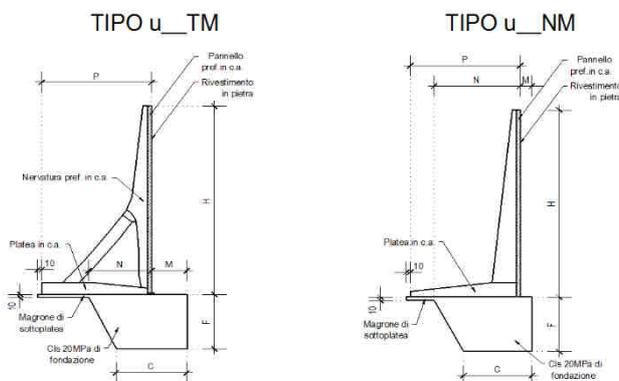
Muri prefabbricati sezioni tipologiche -- Sottovia svincolo SS.131dir
